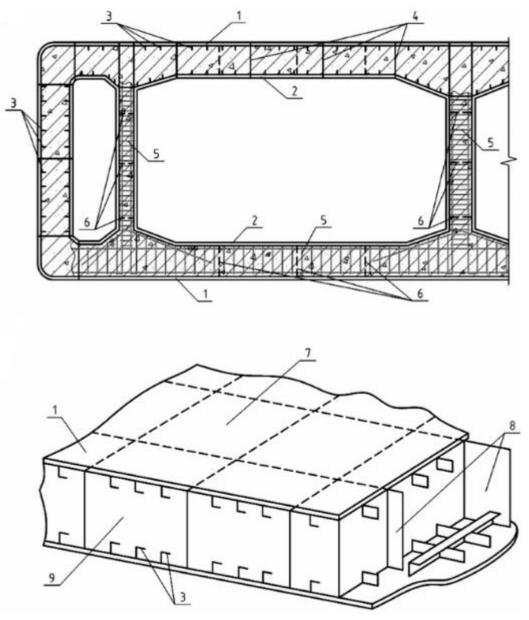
Поперечное сечение сталебетонной тоннельной обделки 1 – внешняя стальная оболочка; 2 – ребра жесткости; 3 – диафрагма; 4 – арматурный каркас; 5 – стяжка; 6 – ячейка; 7 – стальные пластины; 8 – монолитный бетон
